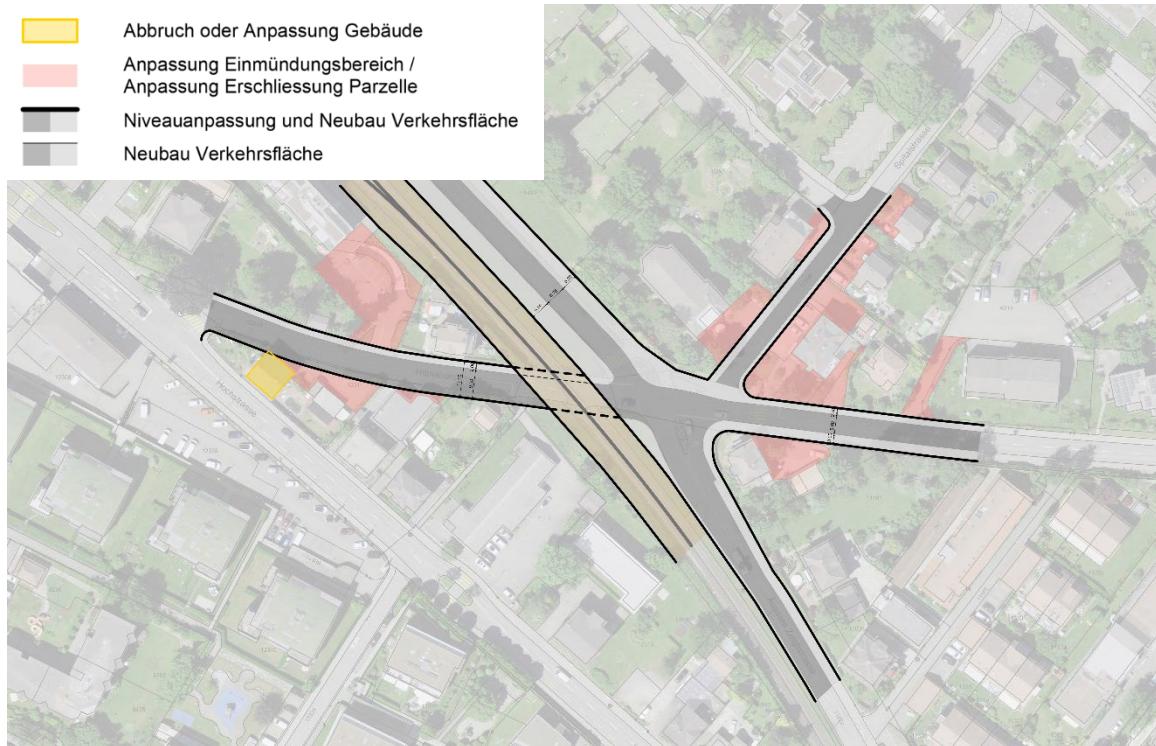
Schemaplan Unterführung Hittnauerstrasse
